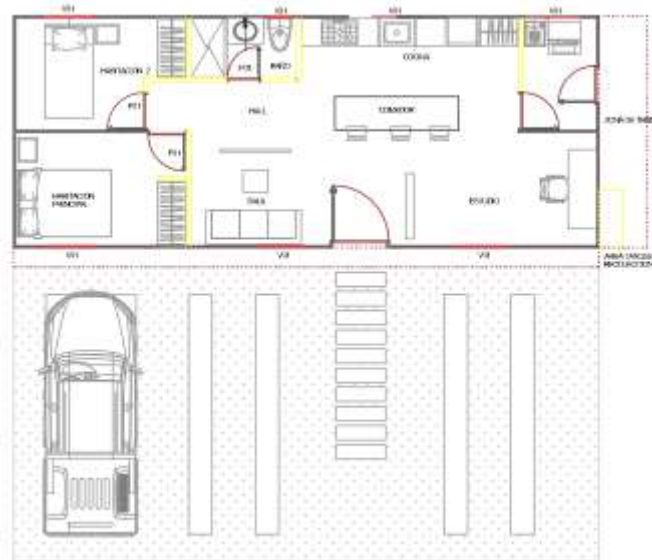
Diseño terminado Planta. Wilson Lozano. 2025
